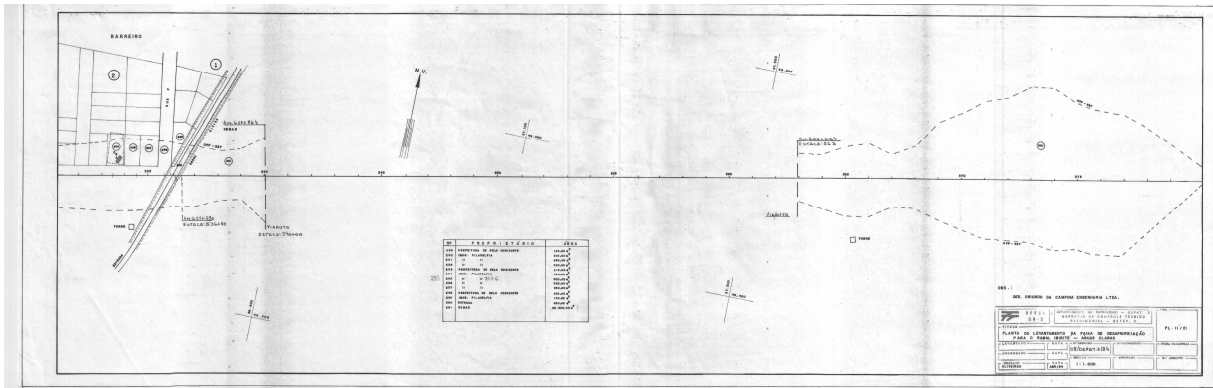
Planta RFFSA 08/DEPAT-3/94 – folha 11/21
